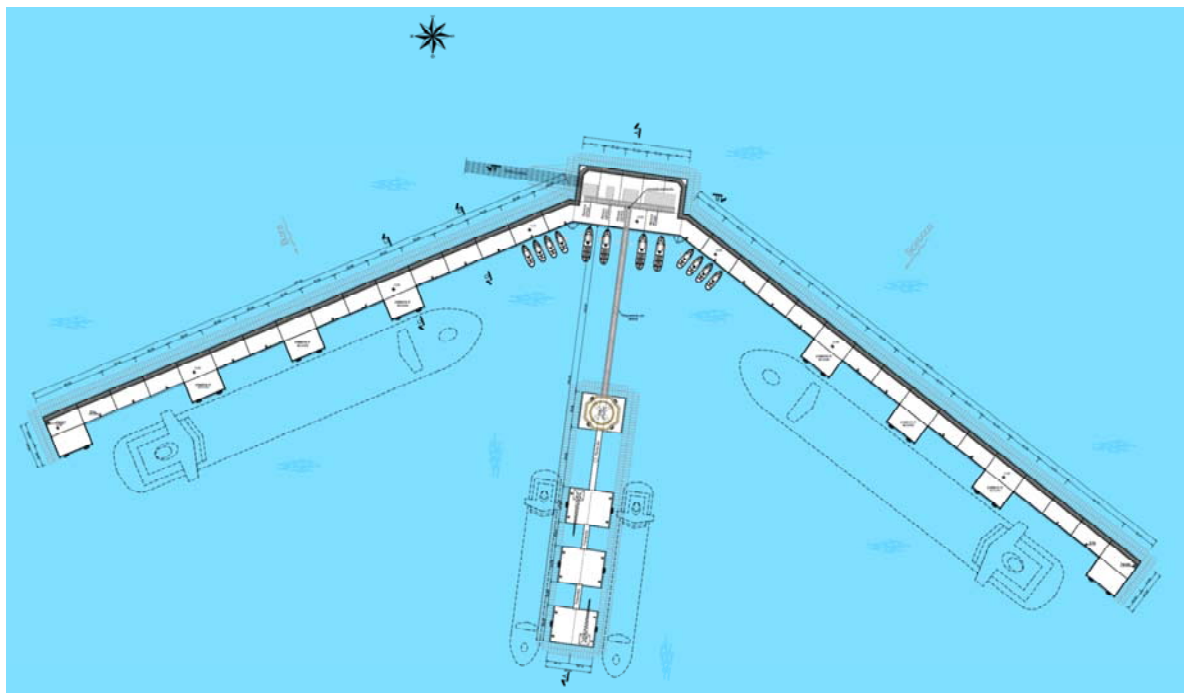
Progetto Preliminare del Novembre 2002 - Planimetria generale del terminal petrolifero off-shore
